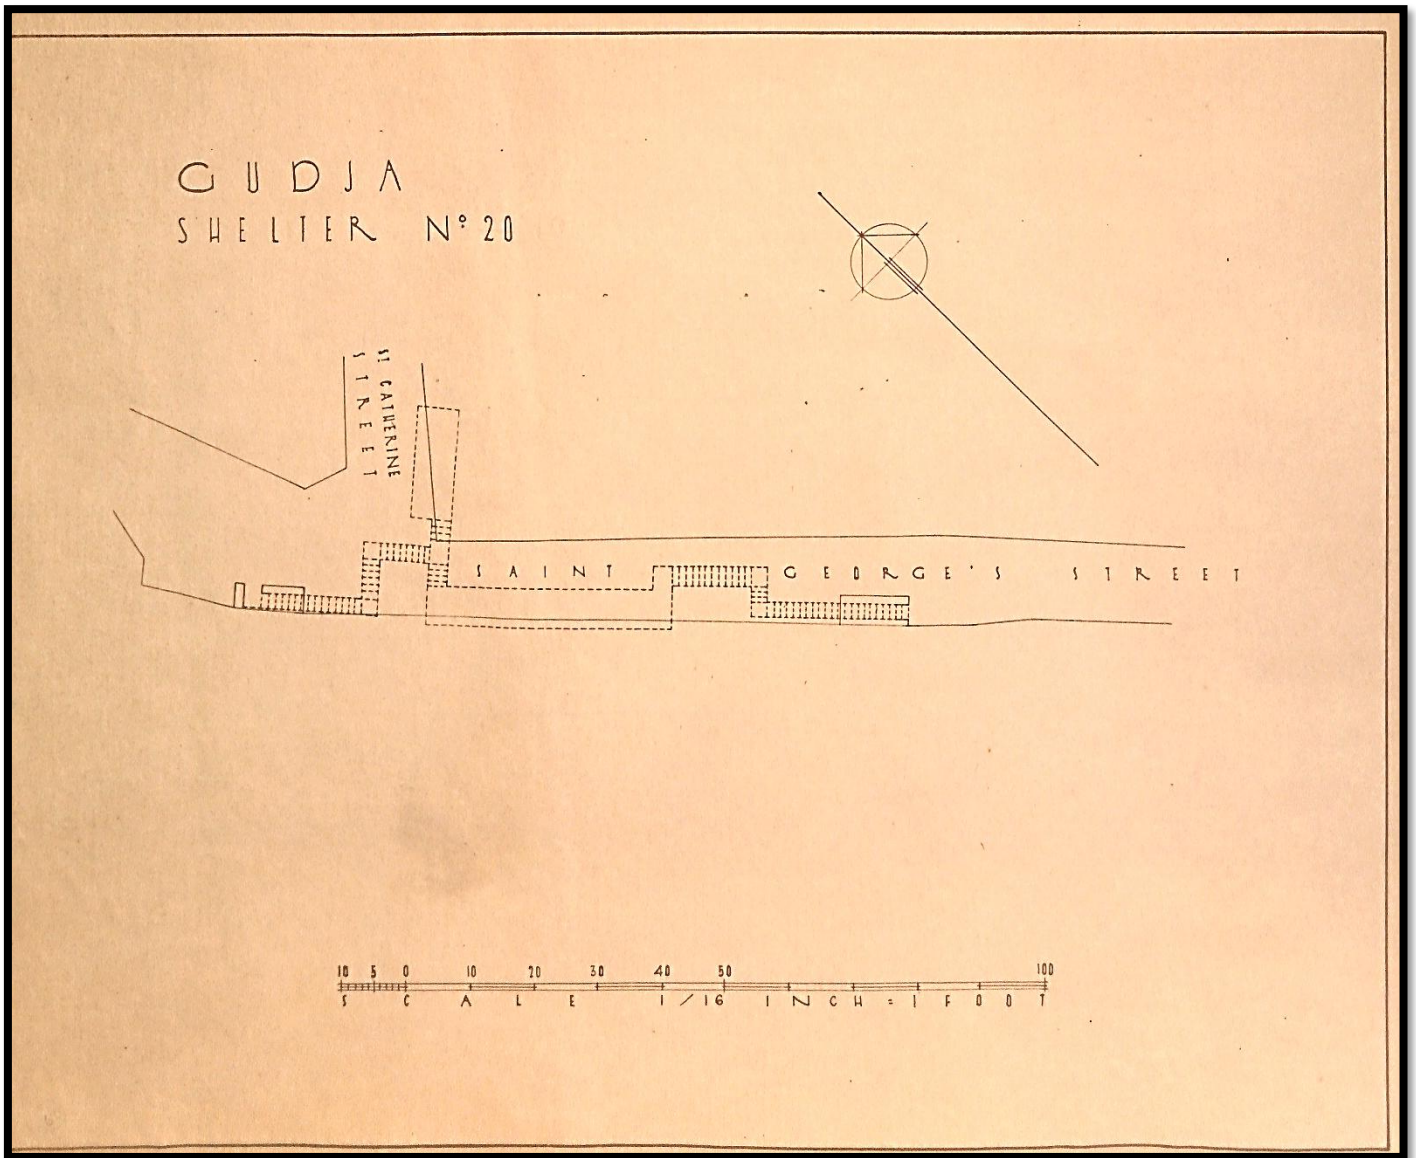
Planta do Abrigo nº20 "St. Catherine Street – Saint George's Street."
